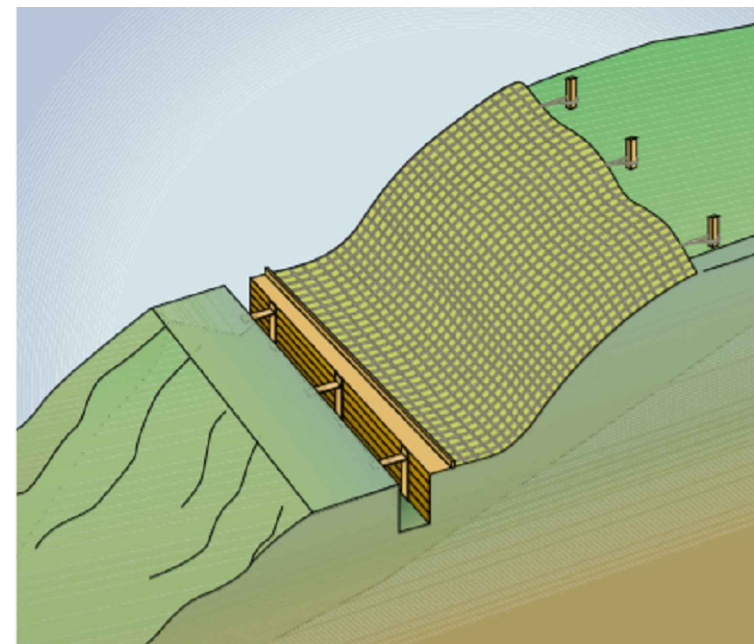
Escavação mista – com paredes em taludes e com paredes protegidas por cortinas
